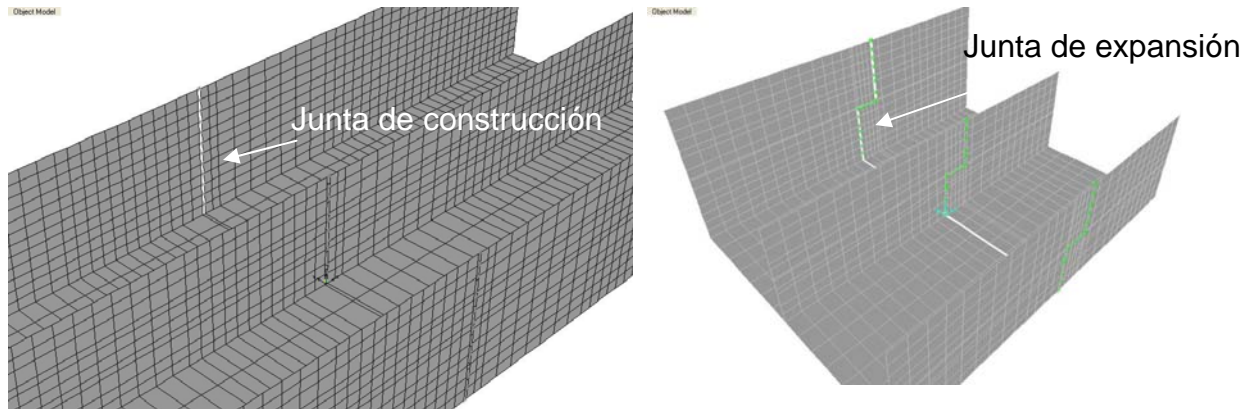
Modelo junta constructiva tipo y junta de expansión
